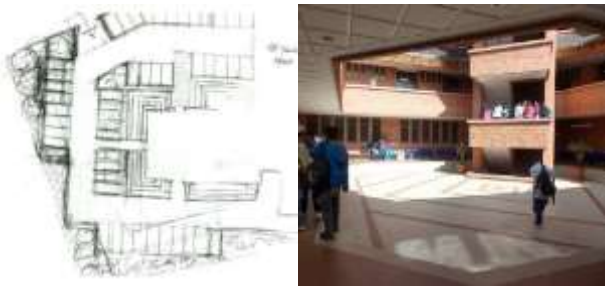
y 14: A la izquierda: vista del patio interior central de la facultad. A la derecha fotografía del patio interior de la facultad.
